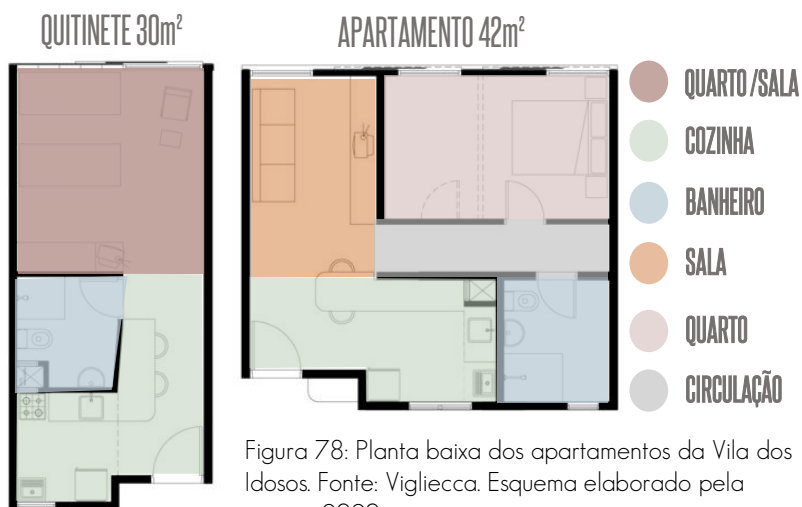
Planta baixa dos apartamentos da Vila dos Idosos. Fonte: Vigliecca. Esquema elaborado pela autora. 2020
